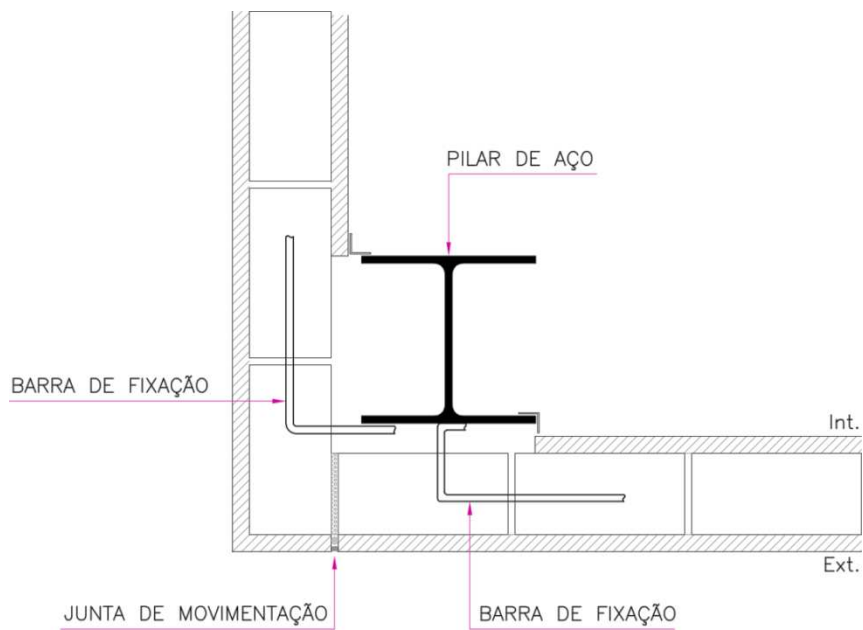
Alvenaria desvinculada de canto fora do plano da estrutura.
